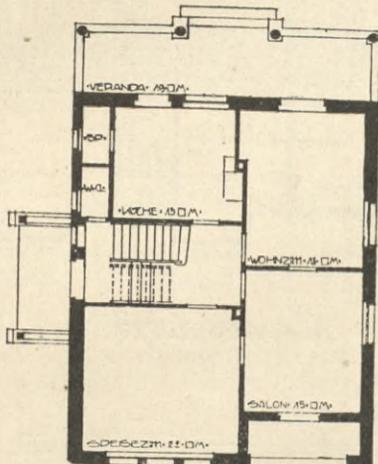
Landhaus Keil in Buchschlag, Erdgeschoß
